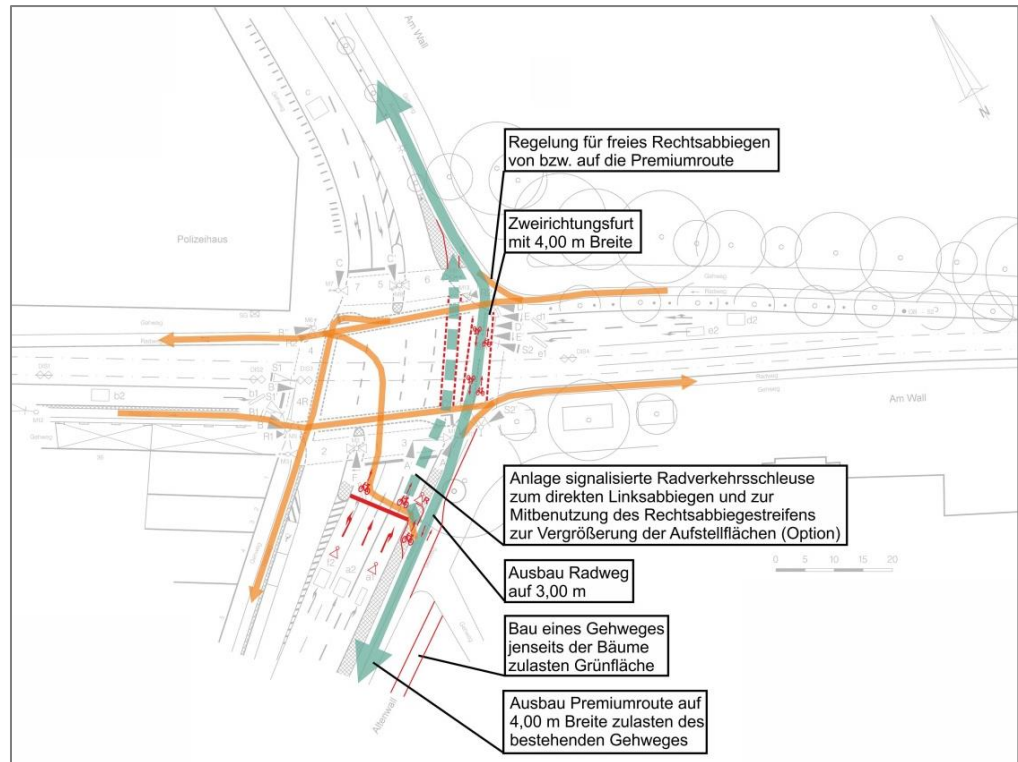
Entwurfsskizze für empfohlene Maßnahmen am Knoten Am Wall/Altenwall
